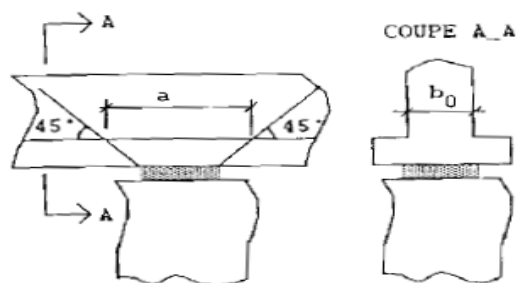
Largeur de bielle « poutre à talon sur appareil d'appui » [1]
